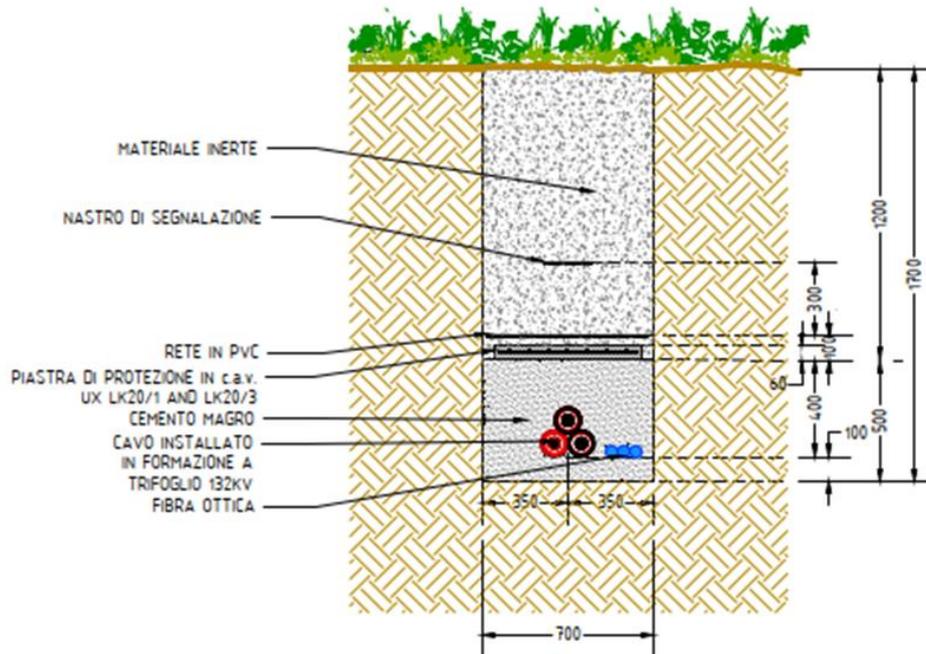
Sezione tipo su terreno - Tratto di cavidotto dalla Stazione di Trasformazione alla Stazione di Consegna
